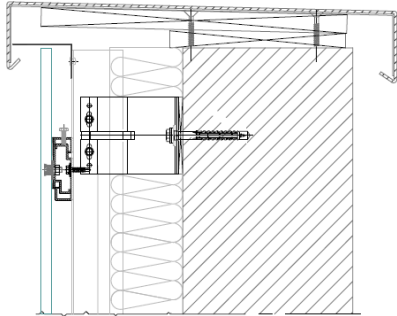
Außenecke mit gewinkelter Kante DKT1.1.
